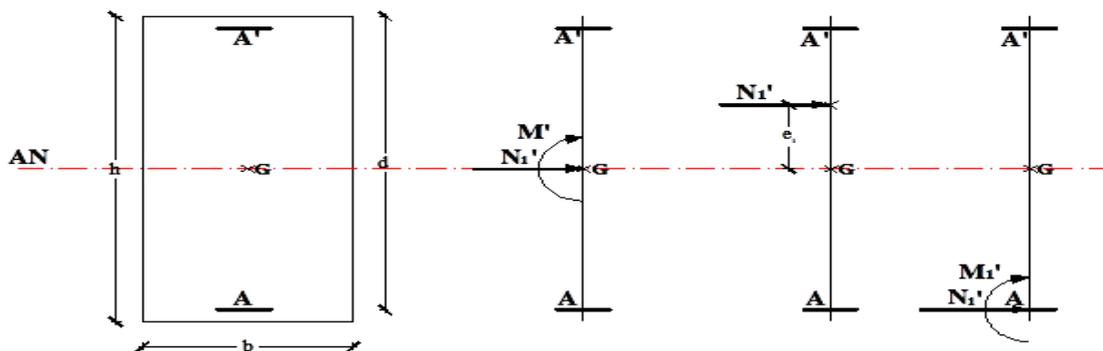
Position de N'_1, M'_1 et M_1 sur la section transversale
